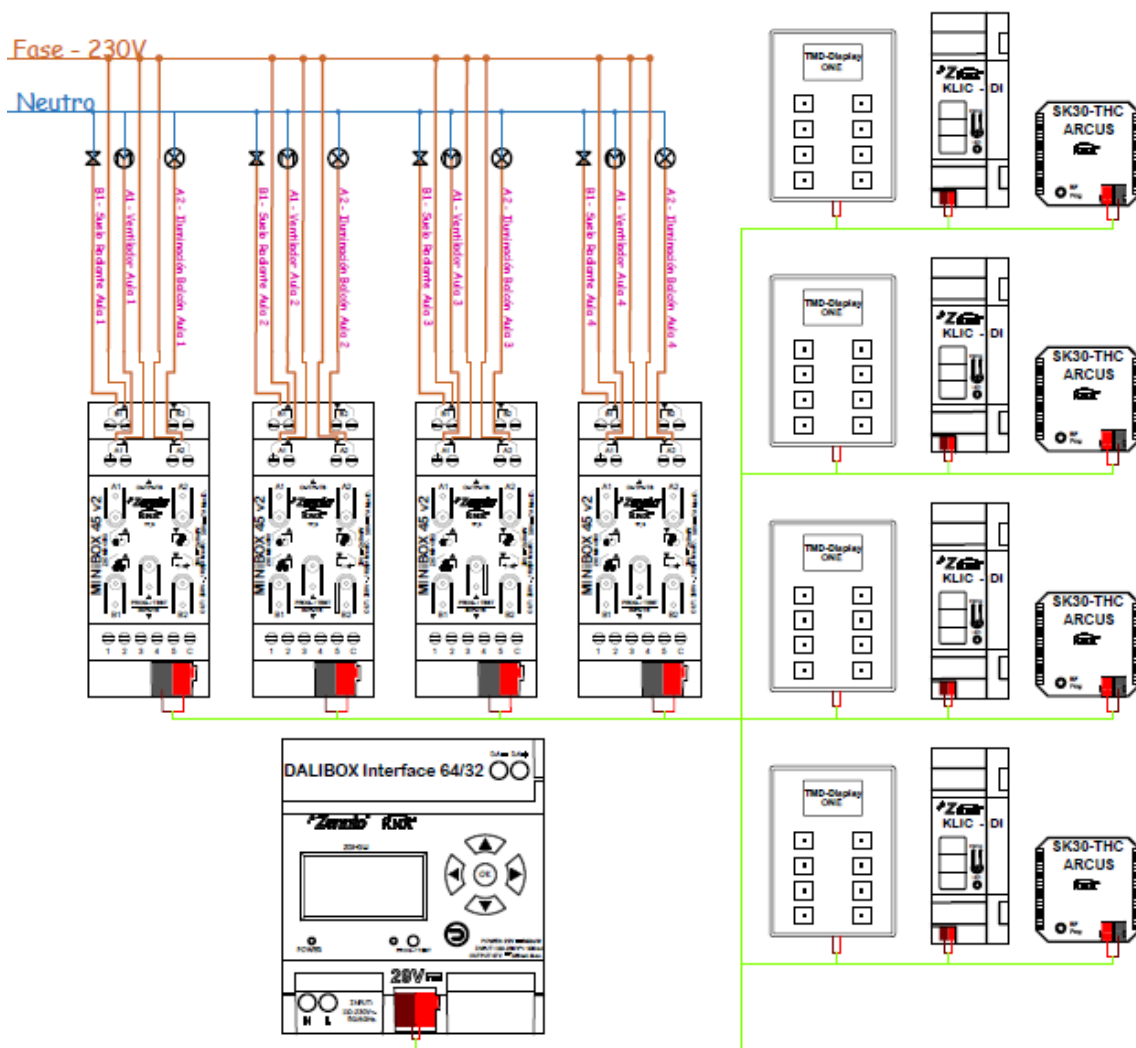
Conexión del sistema de control de la zona de aulas del centro.
